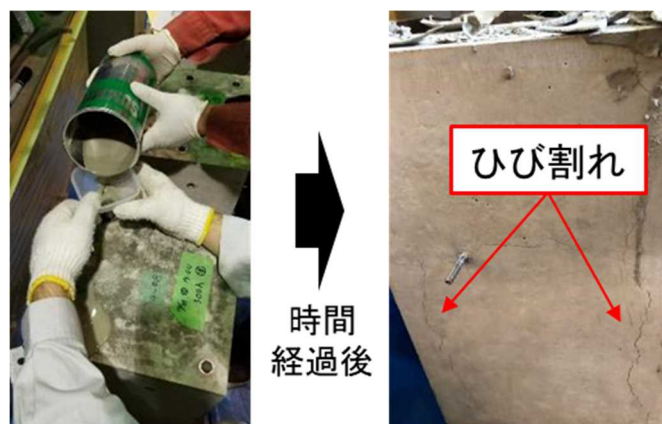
破砕剤充填パイプによるひび割れの例
